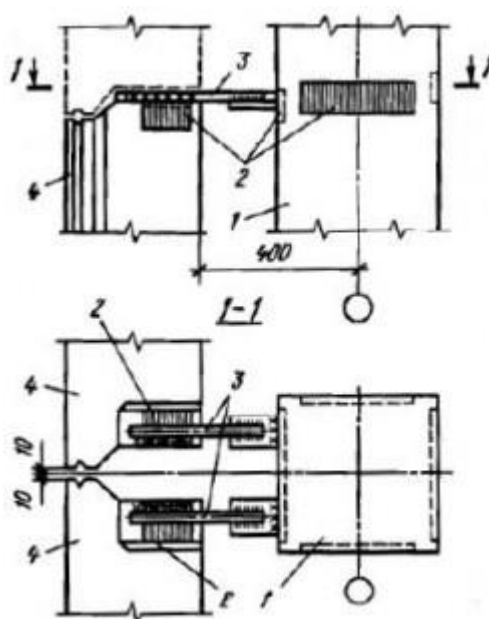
Узел крепление стеновых панелей к колонне каркаса.
